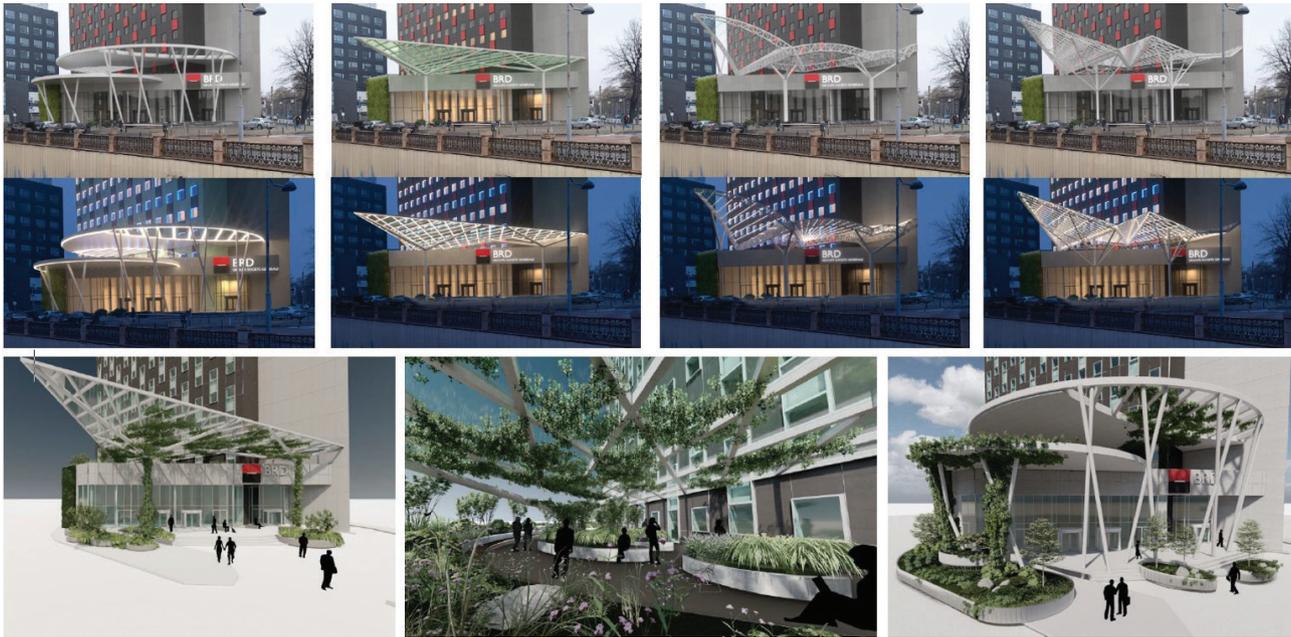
Structuri metalice înălțate și pergole propuse, structuri verzi, pereți verzi și acoperișuri verzi/Proposed elevated metal structures and pergolas, green structures, green walls, and green roofs. Sursa/Source: arhiva personală/personal archive.
